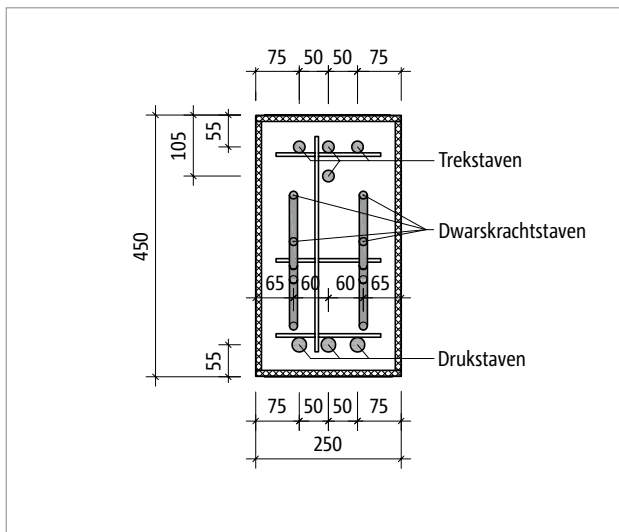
Schöck Isokorf® T type B-M5-V2: Bovenaanzicht
